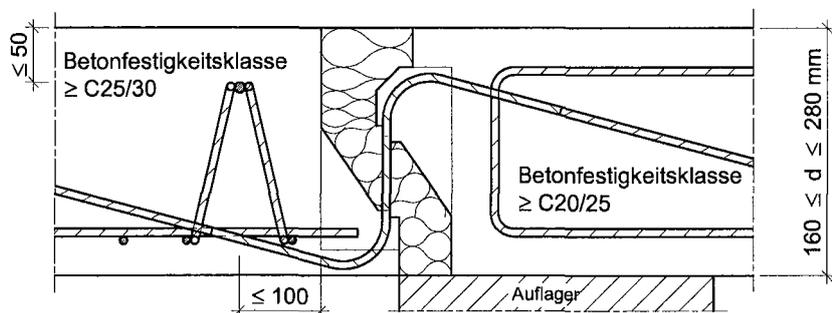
Beispiel Schöck Isokorb Typ V mit Aufhängebewehrung nach Abschn. 3.2.1
